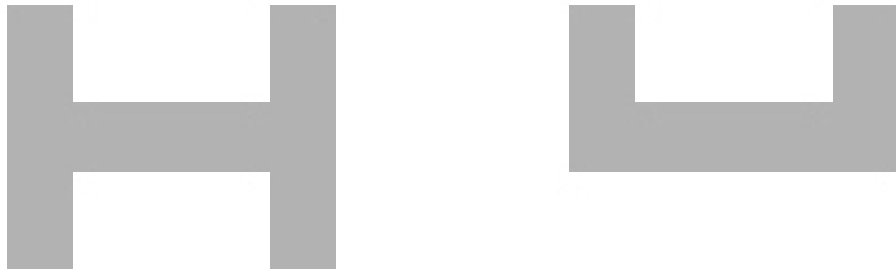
Sections de poutres à profils en "H" et "U"
